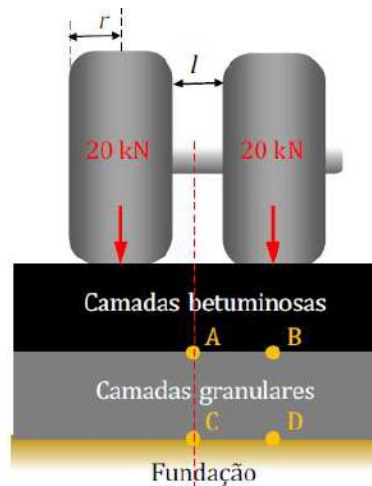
Modelo de resposta do pavimento (adaptado de Shell)
